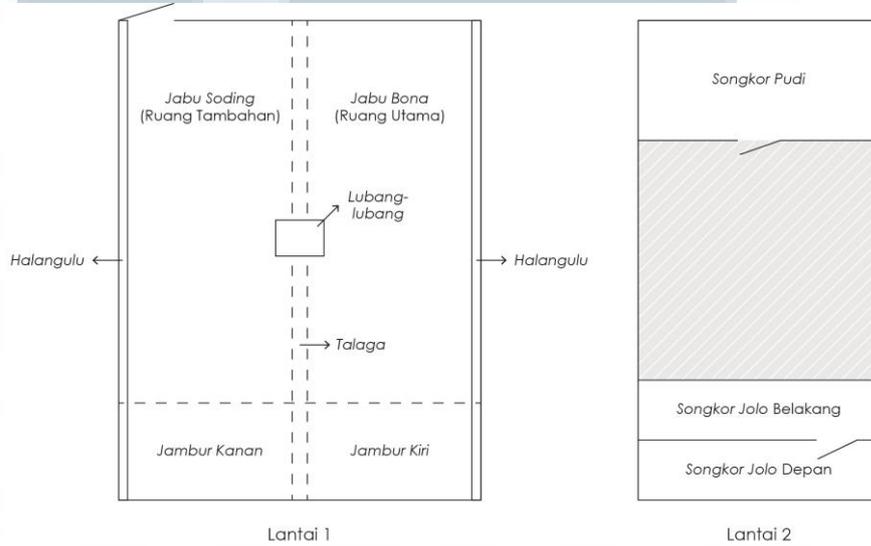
Denah Ruma Gorga secara Vertikal
